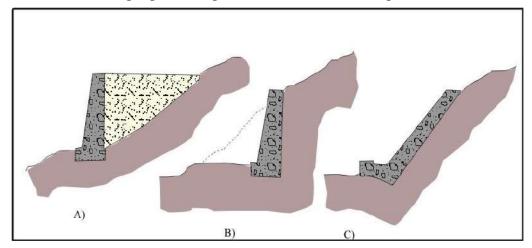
a) Muro de sostenimiento b) Muro de contención c) Muro de revestimiento.
